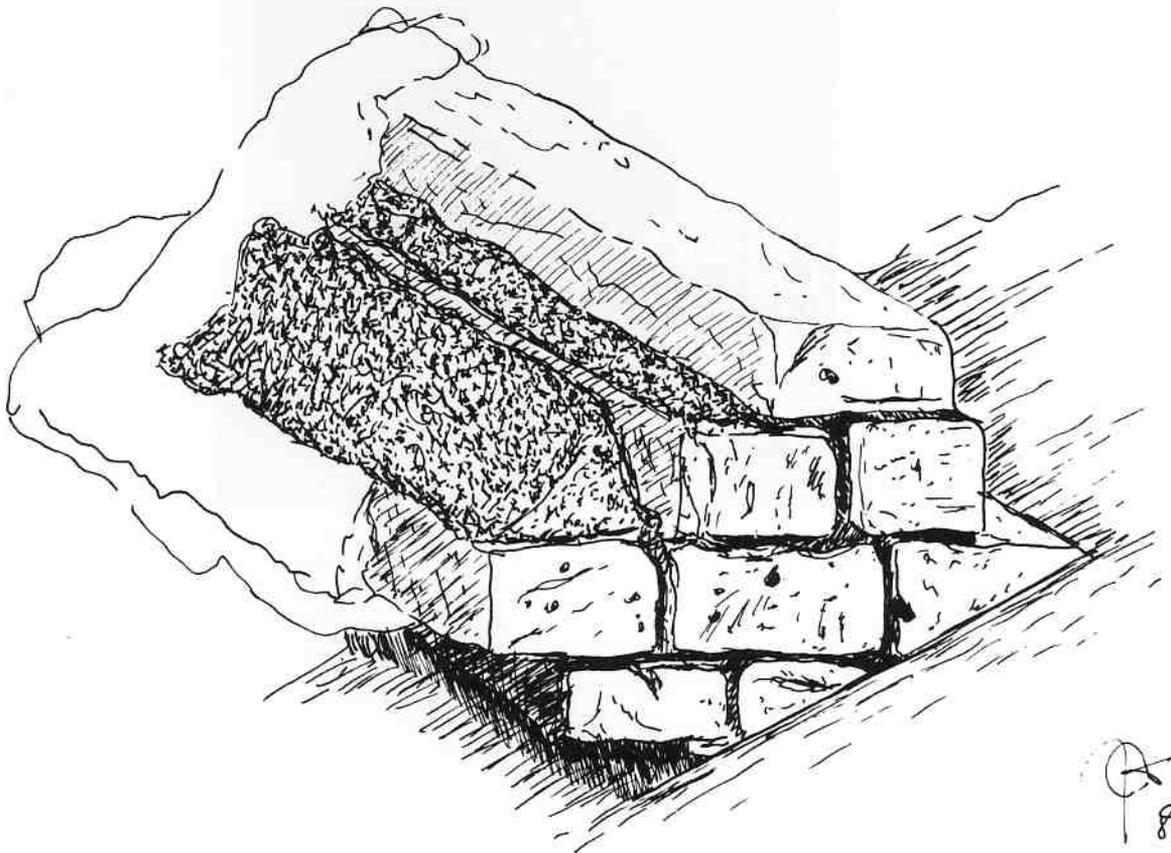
et 7 : Sully-sur-Loire. Pile H, parement.
